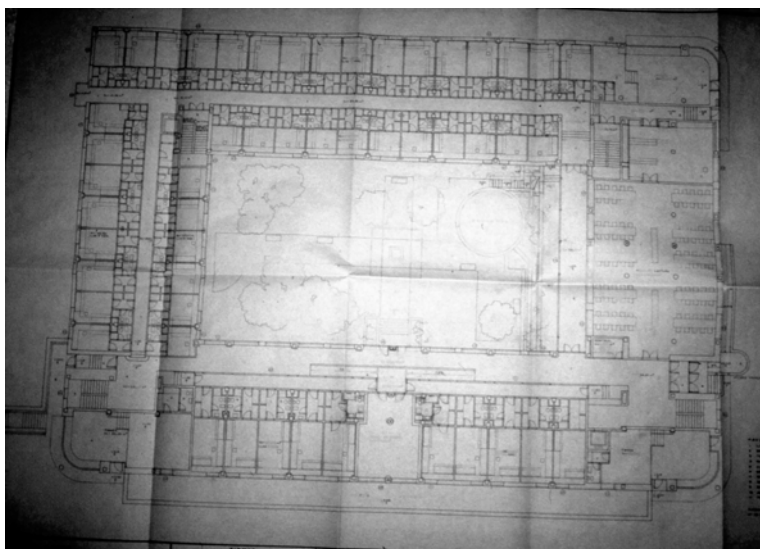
R. U. Colegio Oviedo: planta baja de edificios proyectados en la manzana 19, por J. Cano Lasso y D. Cano Pintos, enero 1991.
